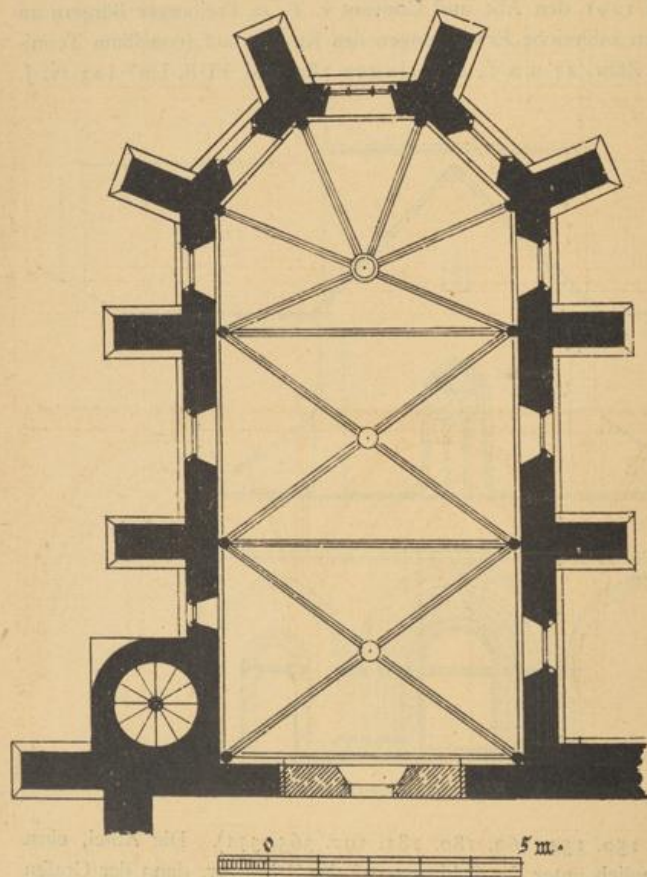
Thennenbach. Grundriss der Kapelle.
